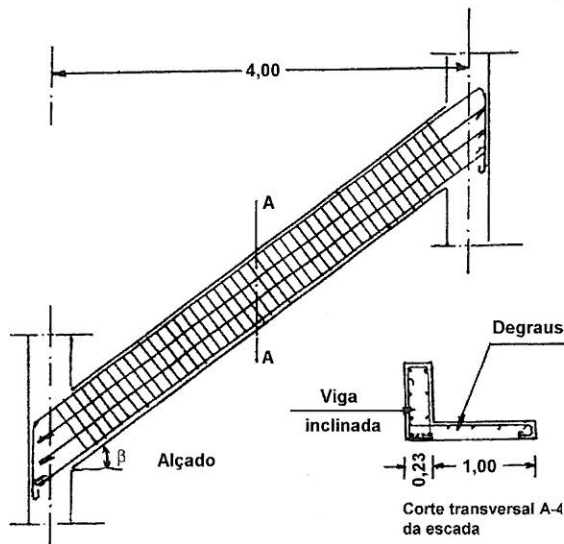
Disposição das armaduras dos degraus e da viga inclinada
